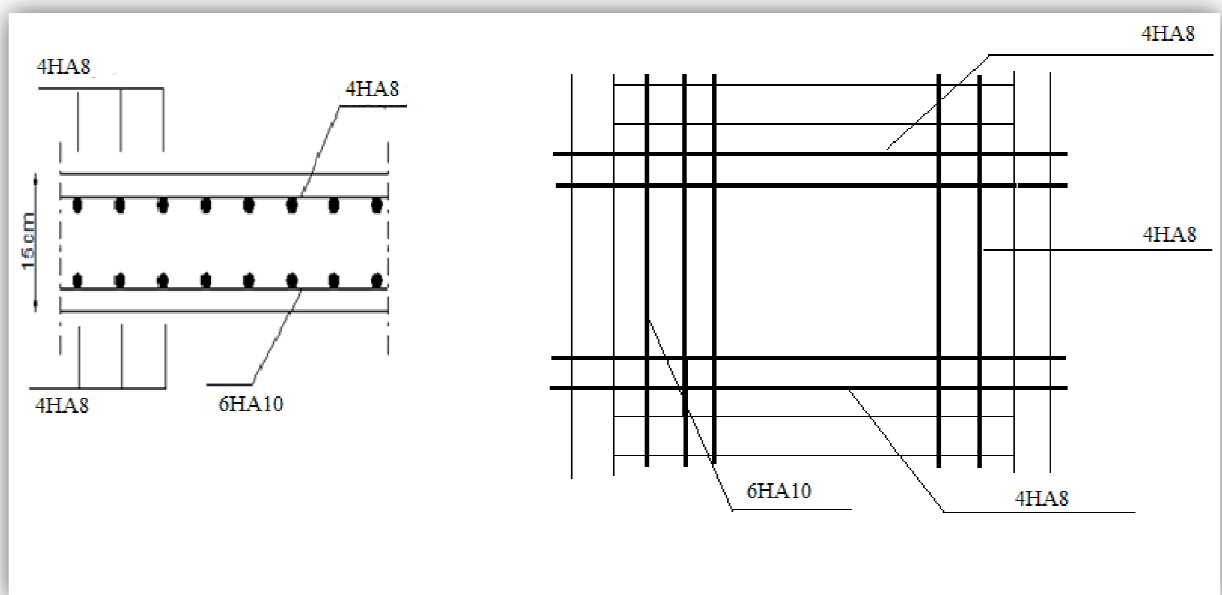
Schéma de ferrailage de dalle pleine (plancher terrasse)
